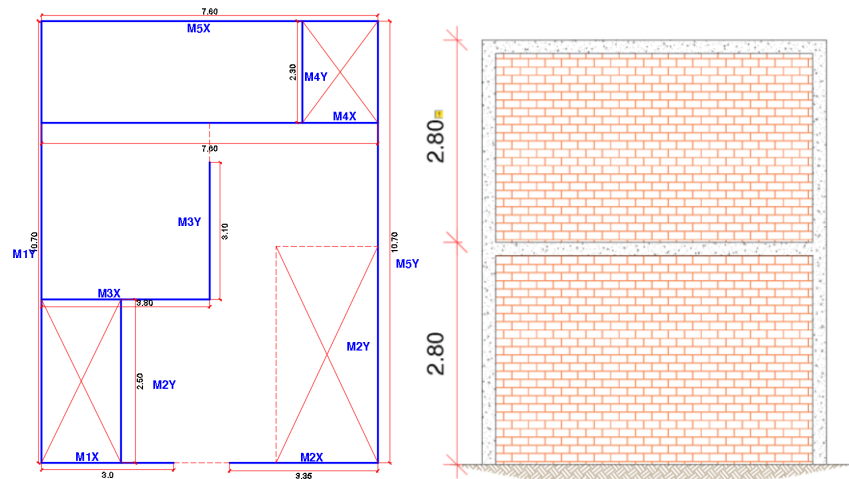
Levantamiento de la edificación analizada 41, plano utilizado para el estudio CH-70
